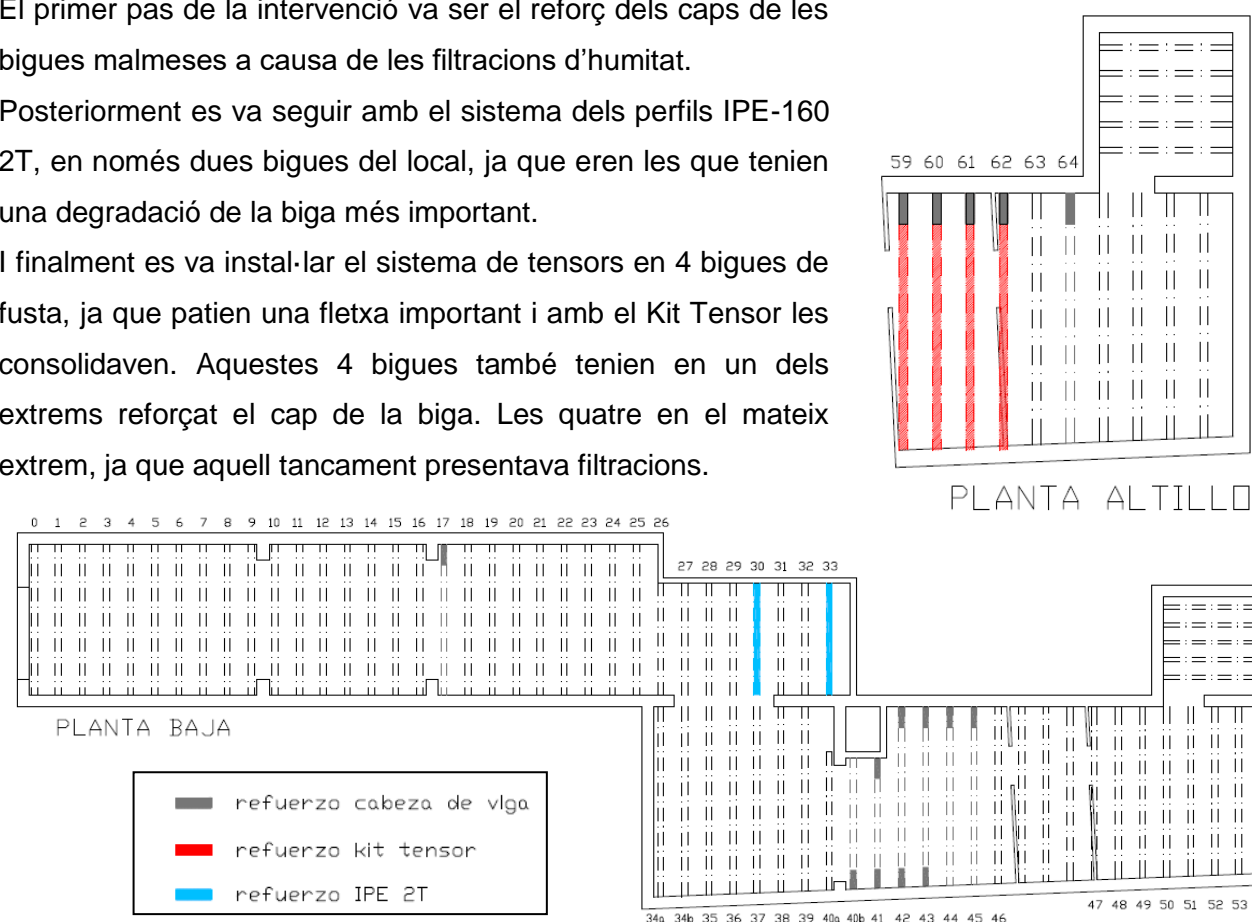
Plànols en planta del local, distribució dels tipus de reforç
